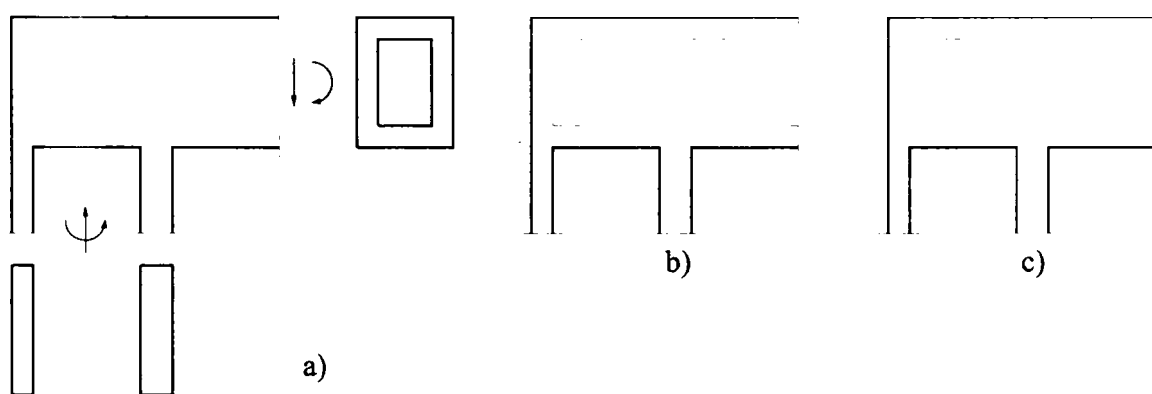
Grindă chesonată ce reazemă pe diafragme din beton armat
